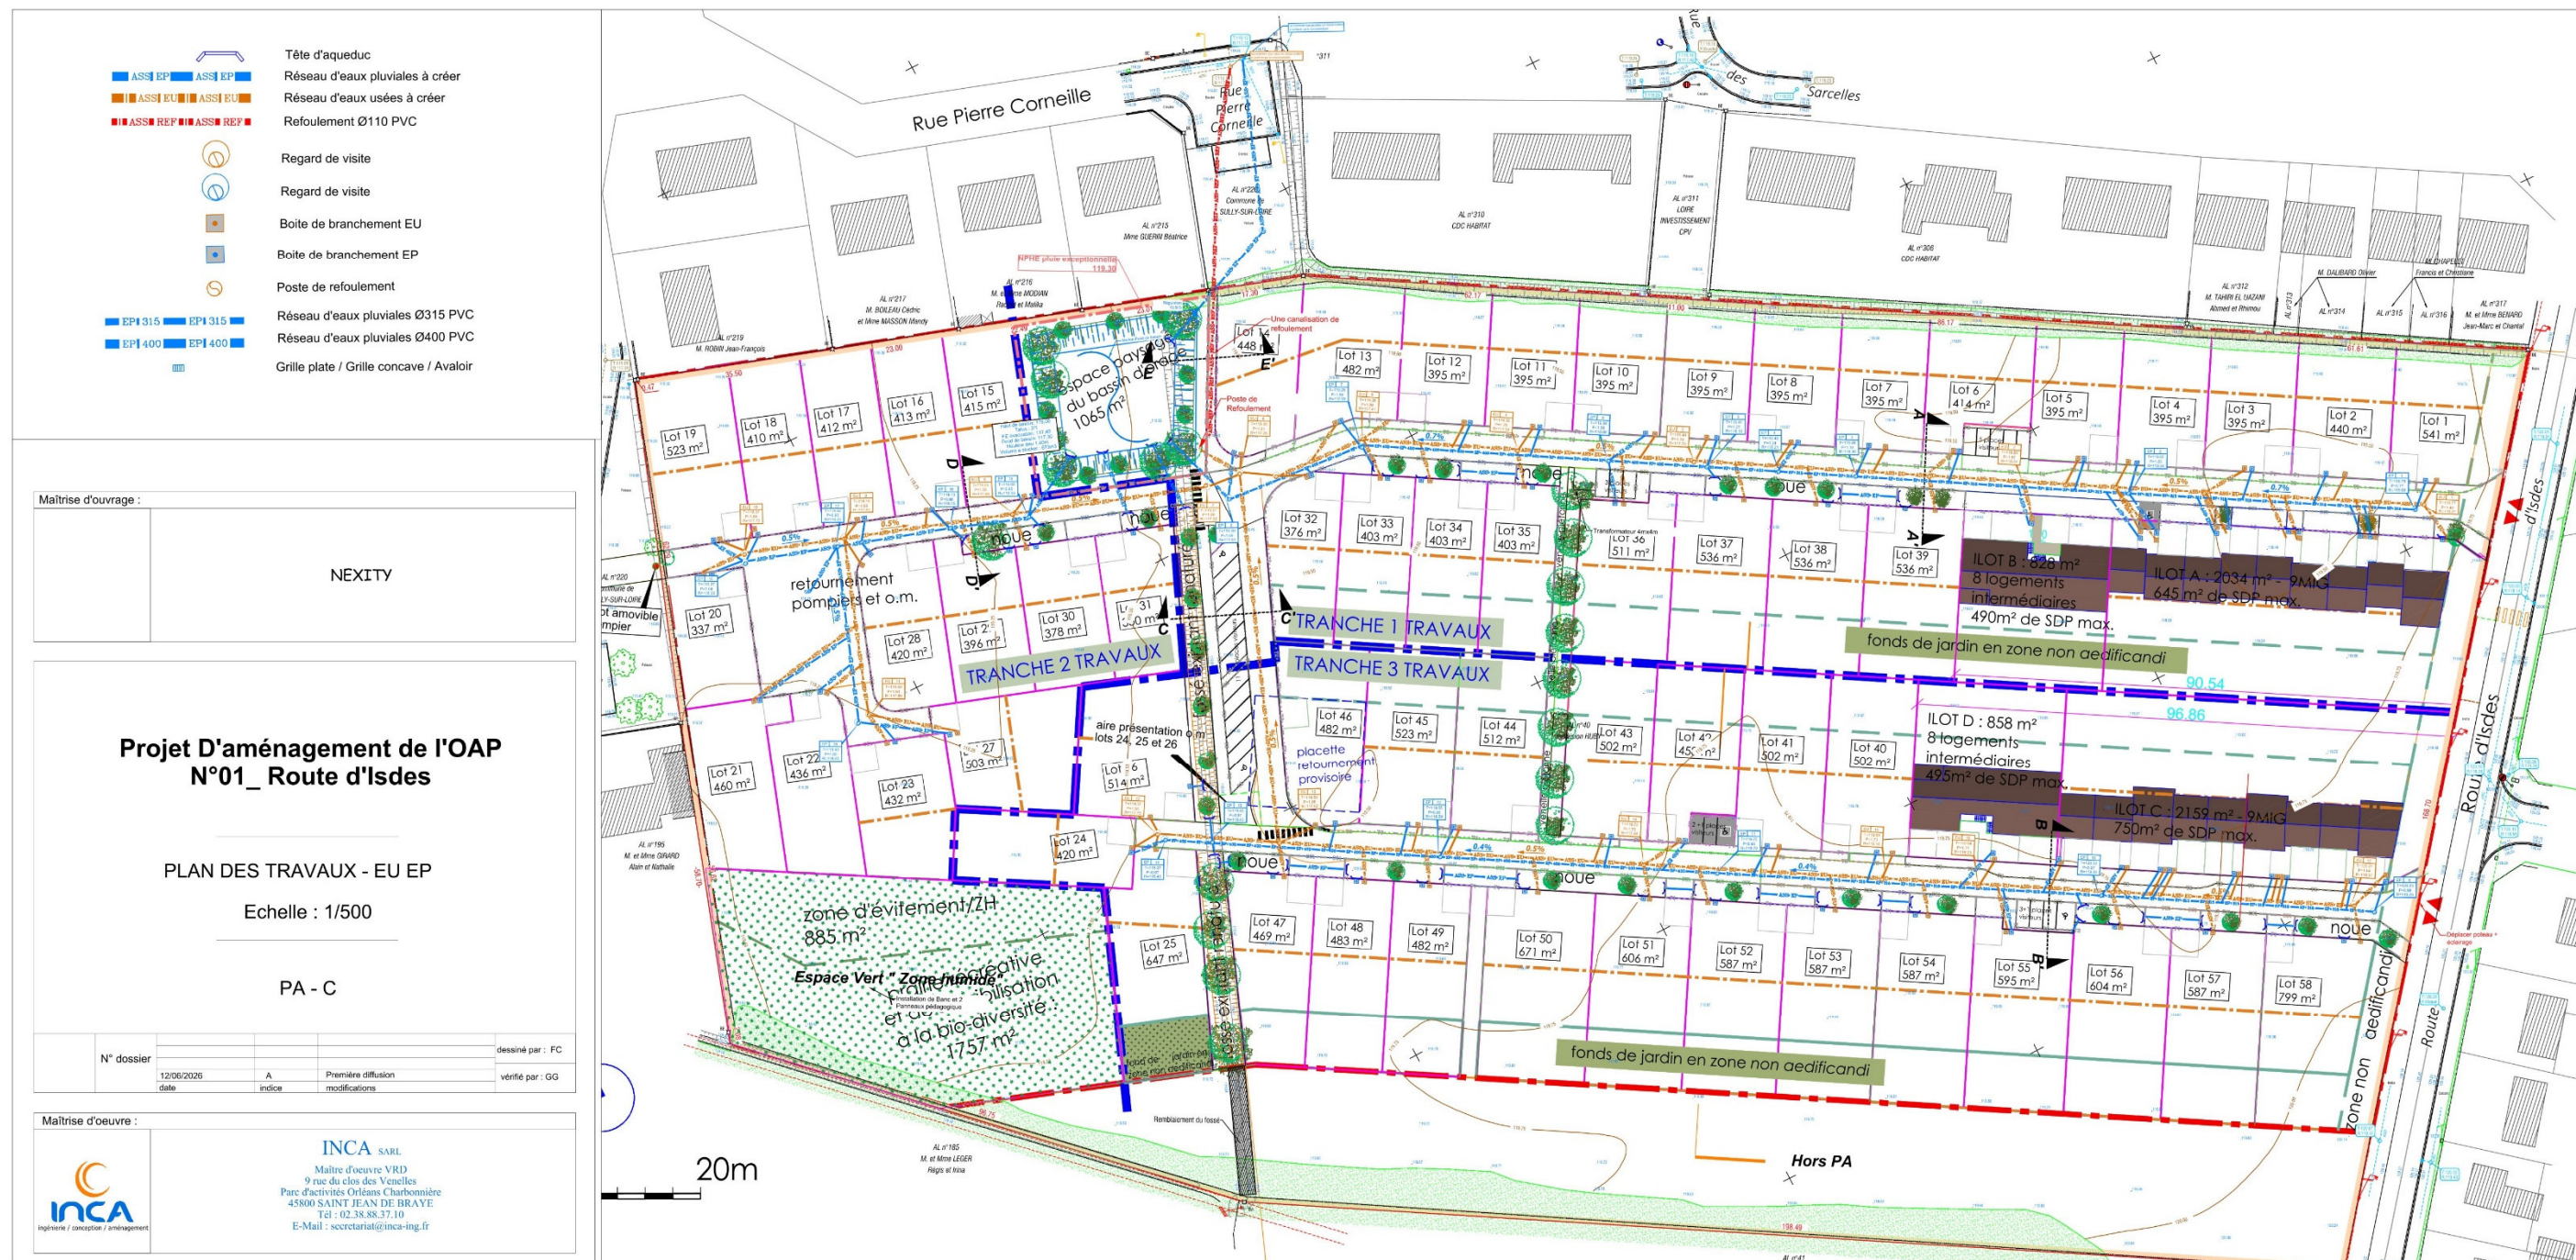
Plan d'assainissement modifié (Juin 2026)
